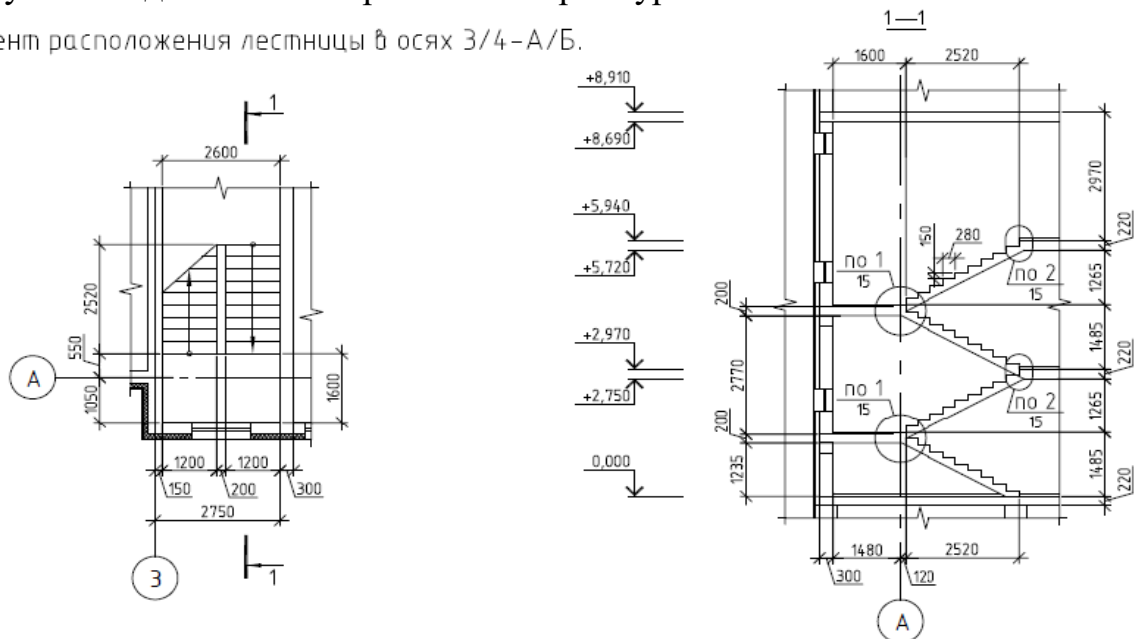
План на отм.0,000 (фрагмент). Разрез по лестничной клетке
